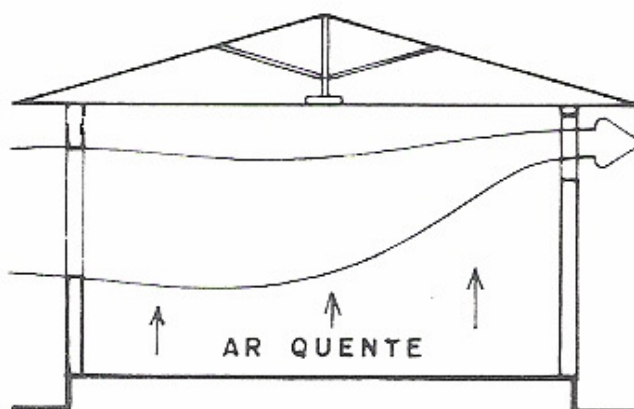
Ilustração do posicionamento da entrada de ar e ventilação.
